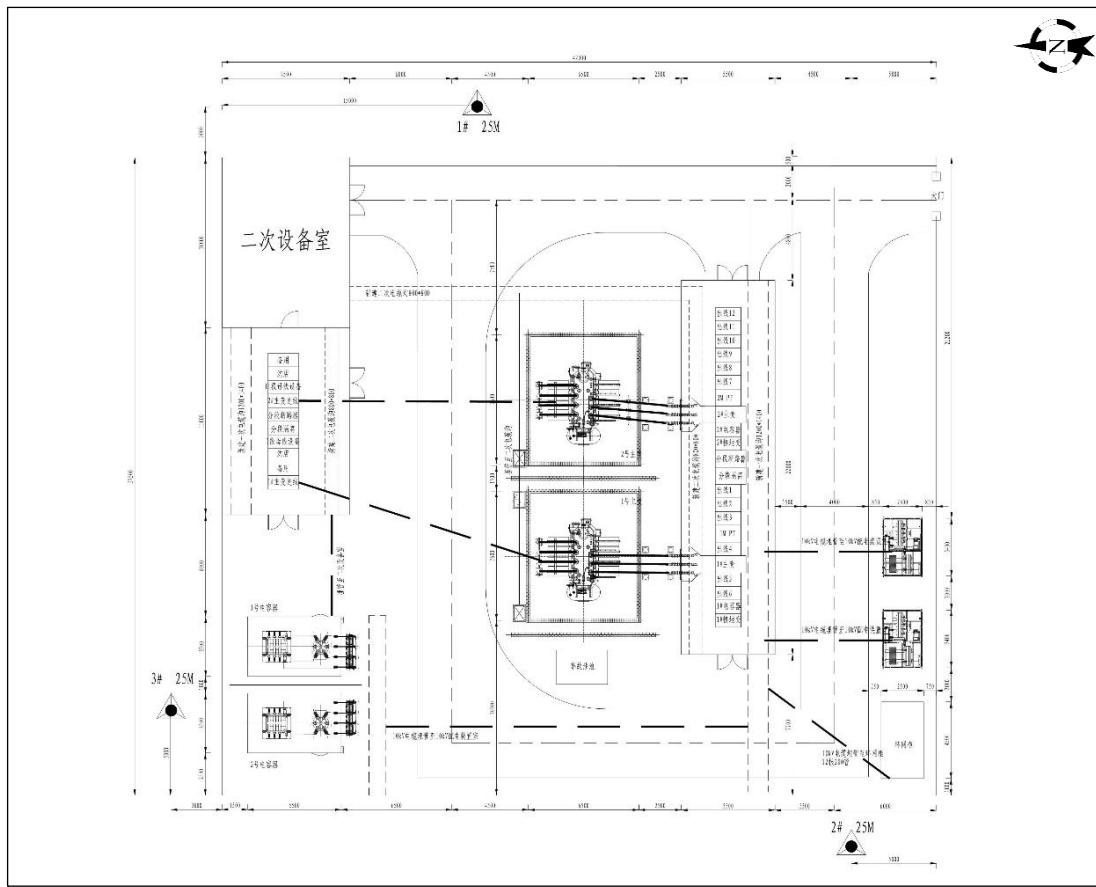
吴邵 35 千伏变电站总平面布置图
